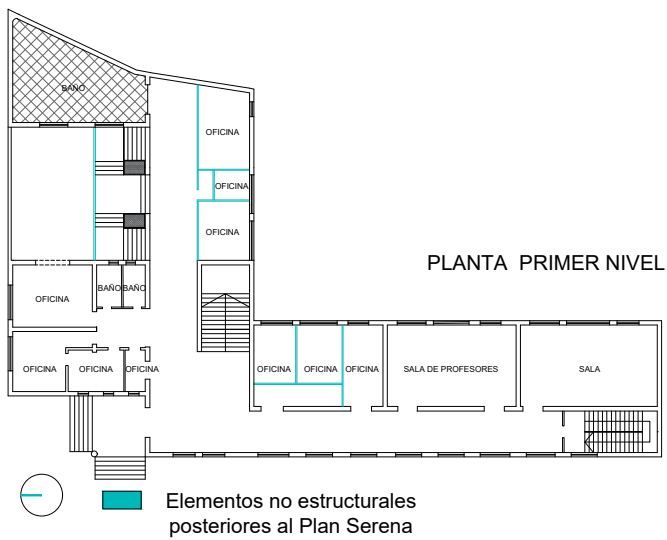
Plantas arquitectura Colegio Japón. Elaboración propia.
